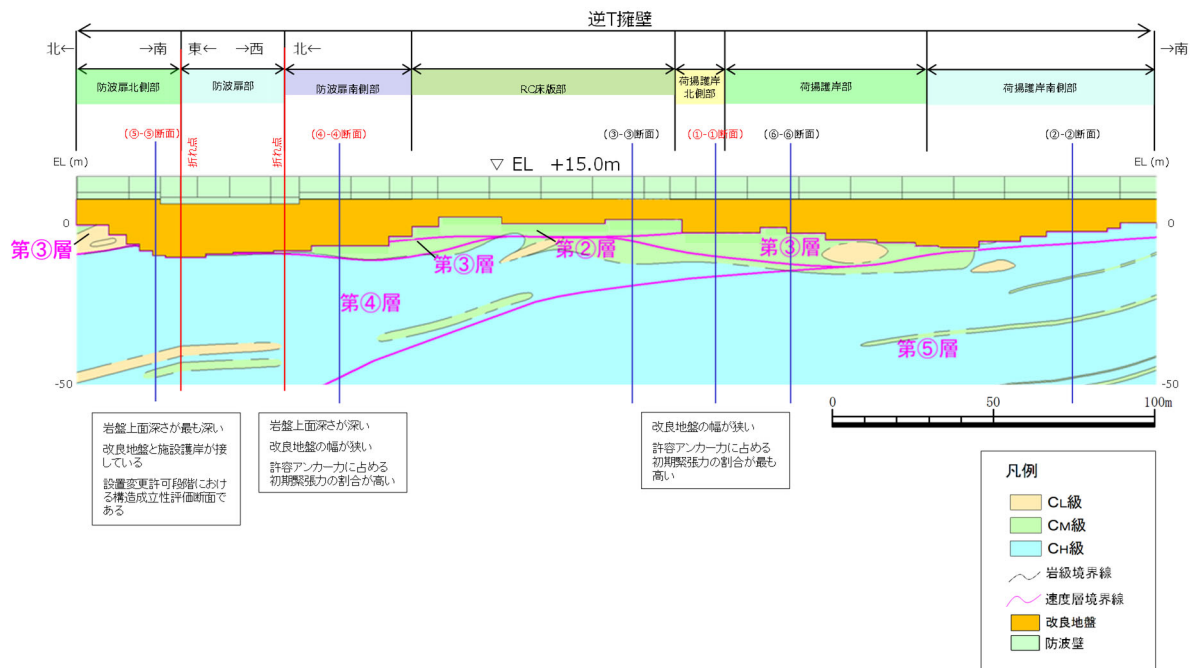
防波壁（逆 T 擁壁）縦断面図
